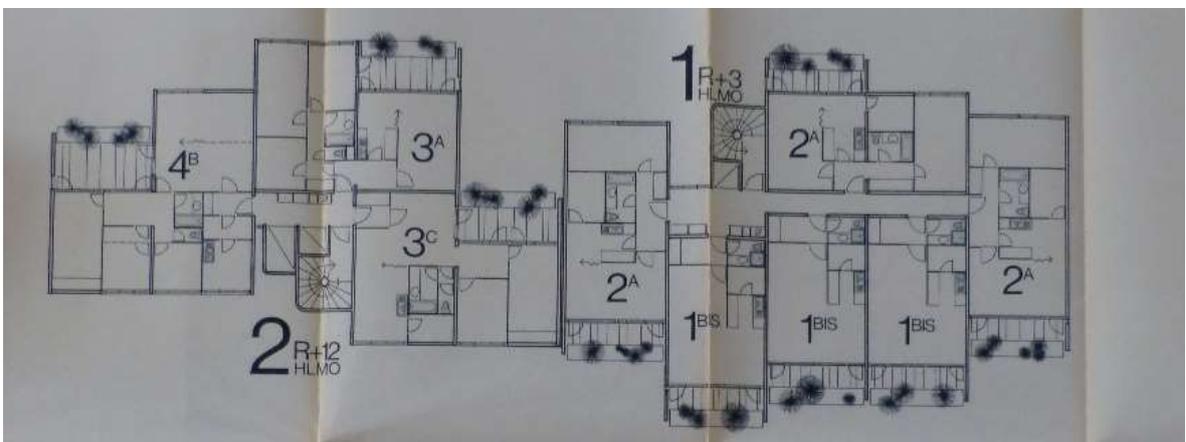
Plan d'étage courant des bâtiments 1 et 2, assemblage des modules. AMVA / Fonds 340W22.
